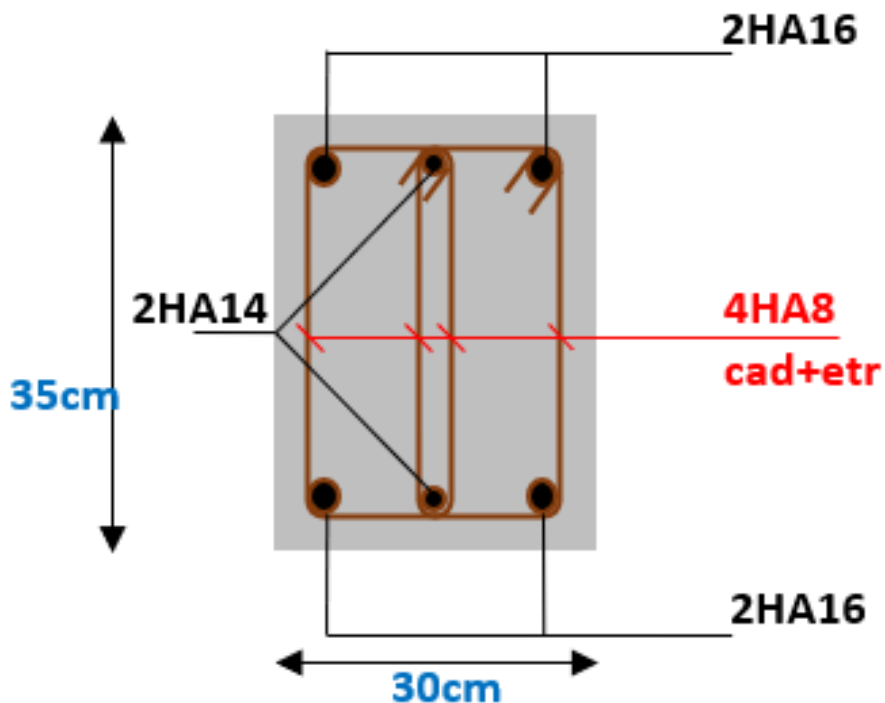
Ferrailage sur travée et en appui de poutre-secondaire (coupe a-a)
